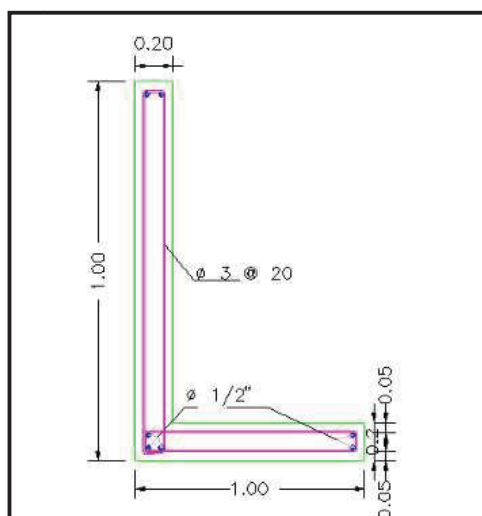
Muro de contención empleado en el Diseño de Pavimentos.
